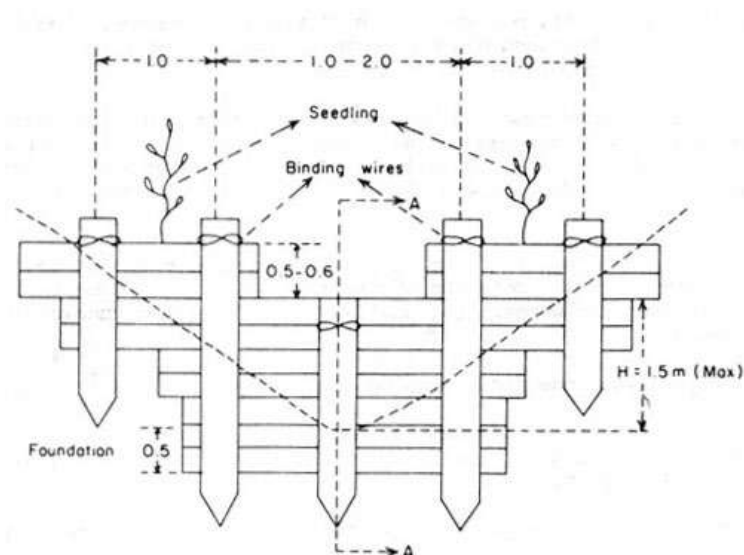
Esquema de construcción de los muros de retención de suelo
